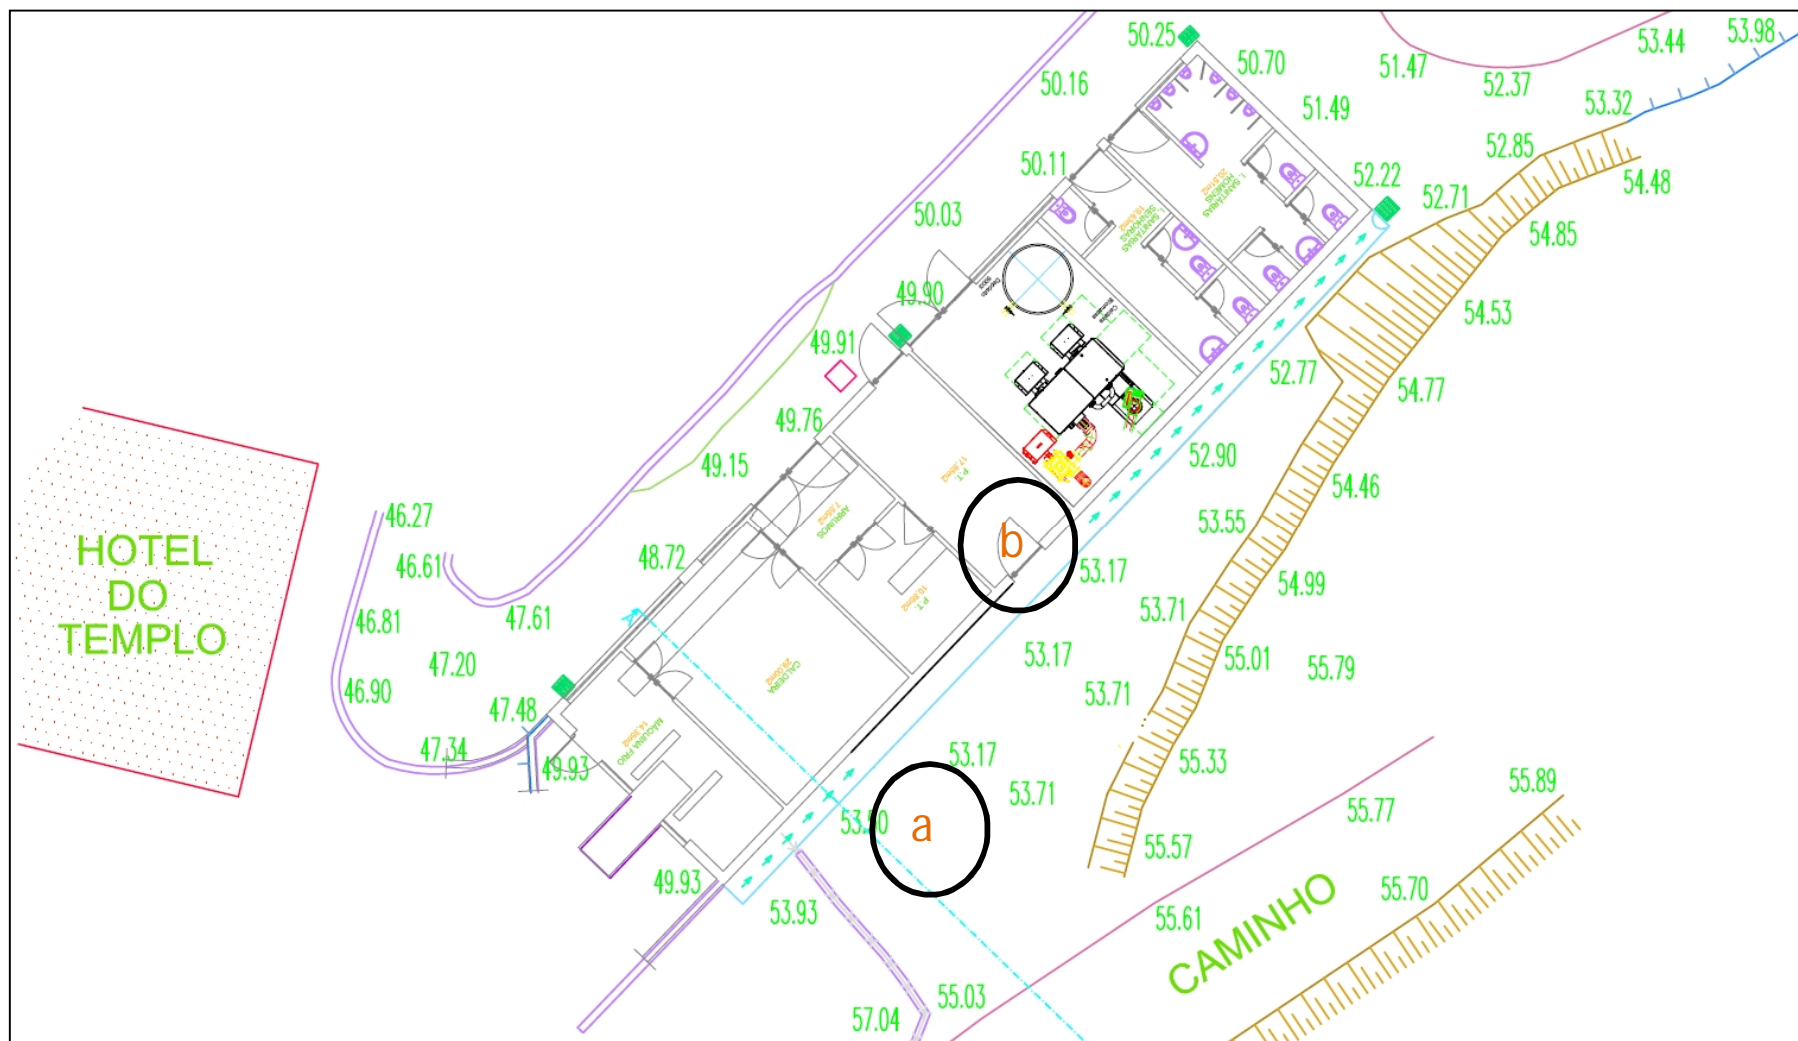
Levantamento topográfico do terreno indicado para construção do silo
